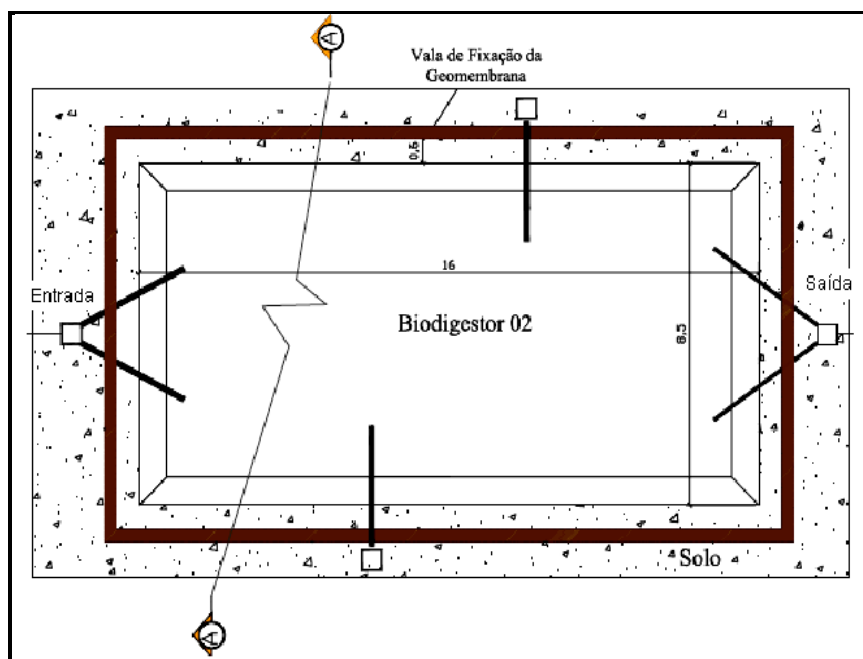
Planta baixa do biodigestor 2 da UGC.
